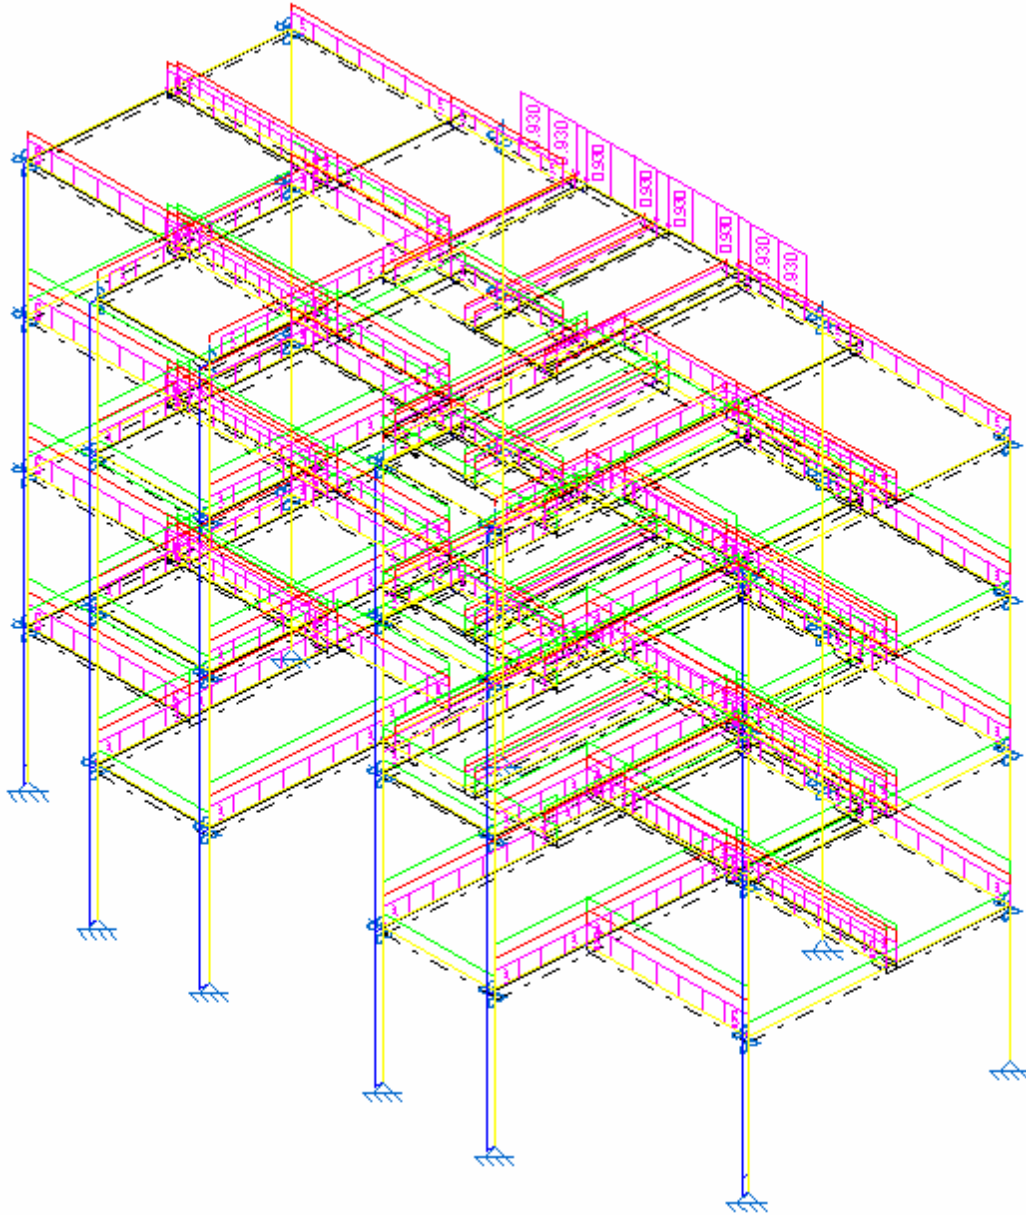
ORIENTAÇÃO DAS NERVURAS DAS LAJES PRÉ-MOLDADAS
